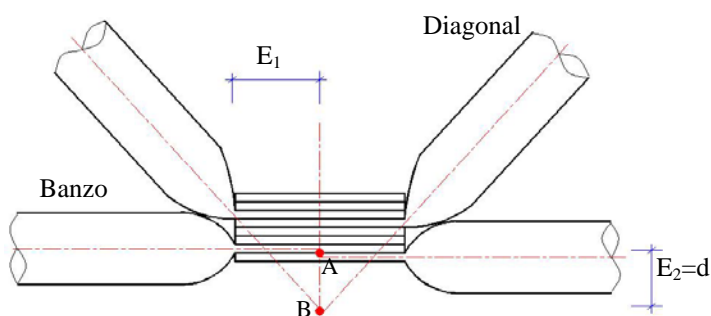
Excentricidade no nó típico de estruturas treliçadas tridimensionais
